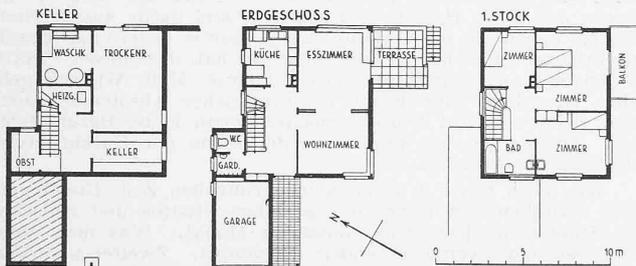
Grundrisse Haus Tagmann. — Masstab 1:400.
